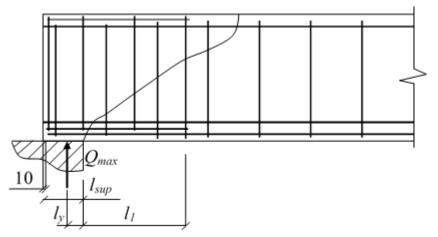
Размеры в опорной части элемента к расчету наклонных сечений
